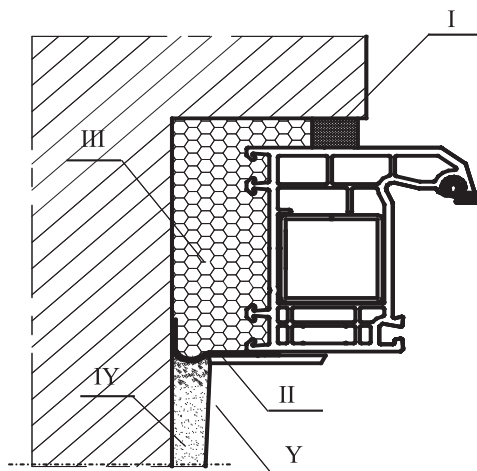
Принципиальная схема монтажного шва: I – наружный водоизоляционный паропроницаемый слой; II – центральный теплоизоляционный слой; III – внутренний пароизоляционный слой; IV – утепляющий термовкладыш; Y – облицовка оконных откосов.
